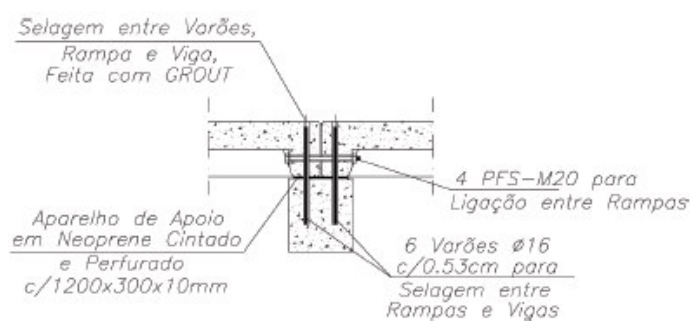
Pormenor de ligação entre rampas e viga cachorro [14].
